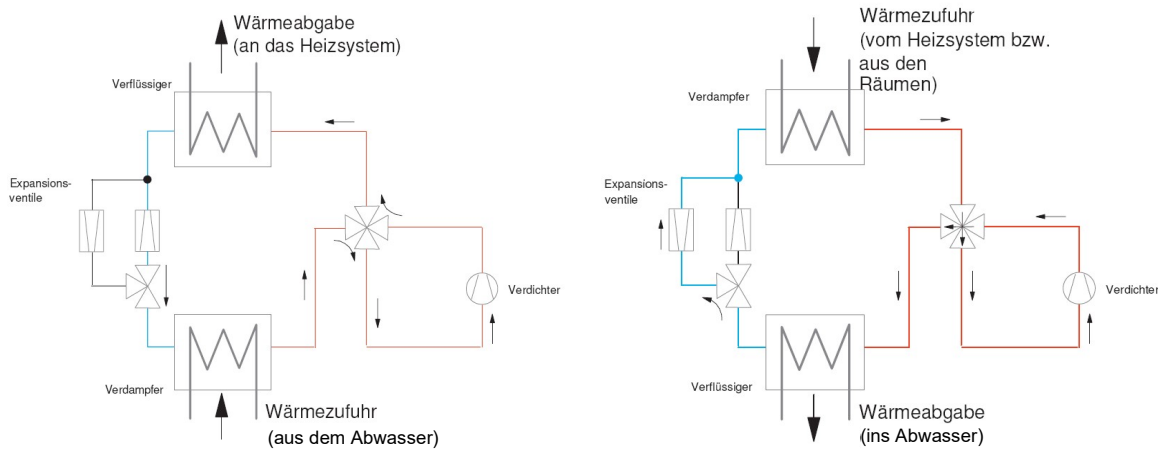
Vereinfachtes Funktionsschema einer Wärmepumpe mit umkehrbarer Betriebsweise im Heizbetrieb (links) und im Kühlbetrieb (rechts), modifiziert nach /5/
